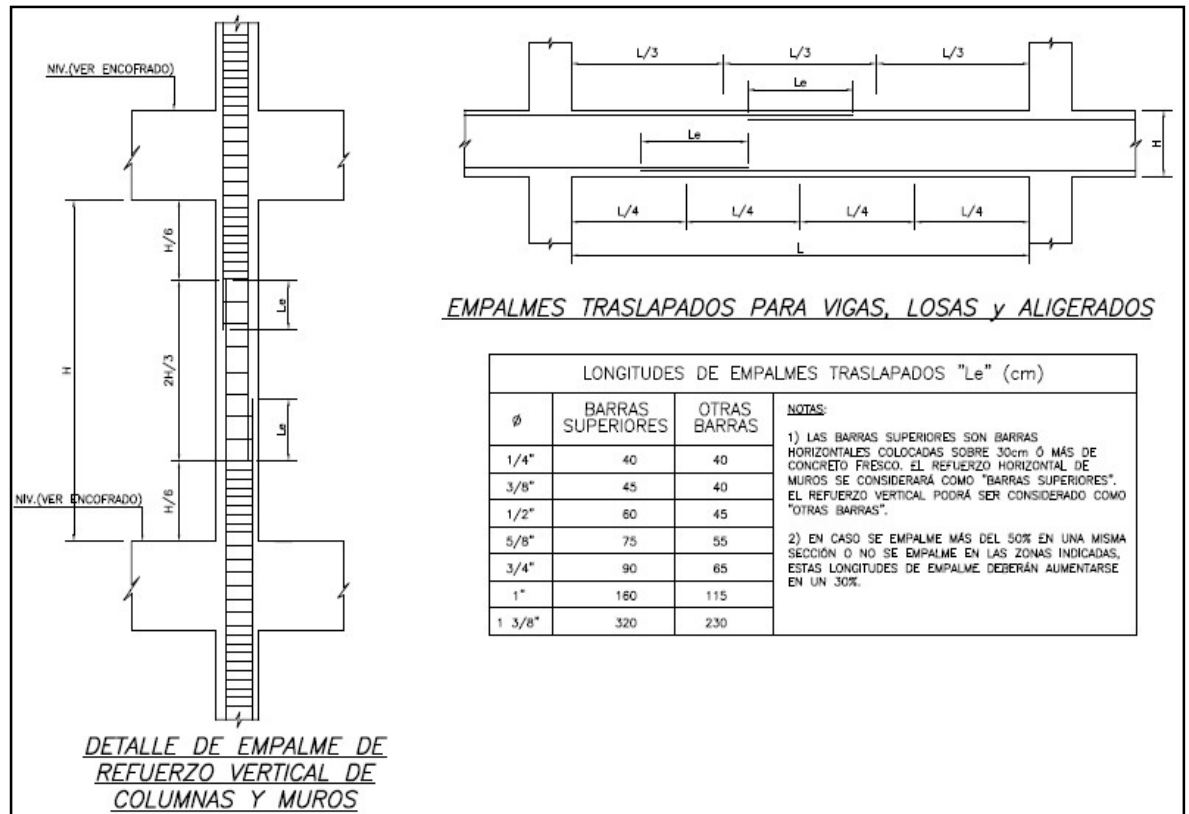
Empalmes en Vigas, Columnas y Placas.
